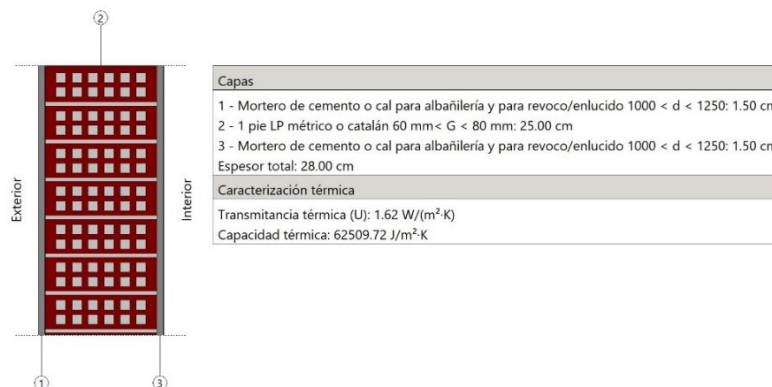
Detalle muro de carga (Elaboración propia, 2024)
